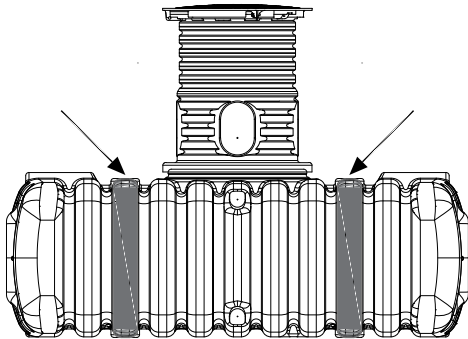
Vue en coupe des tubes de renfort – FLAT S/M
